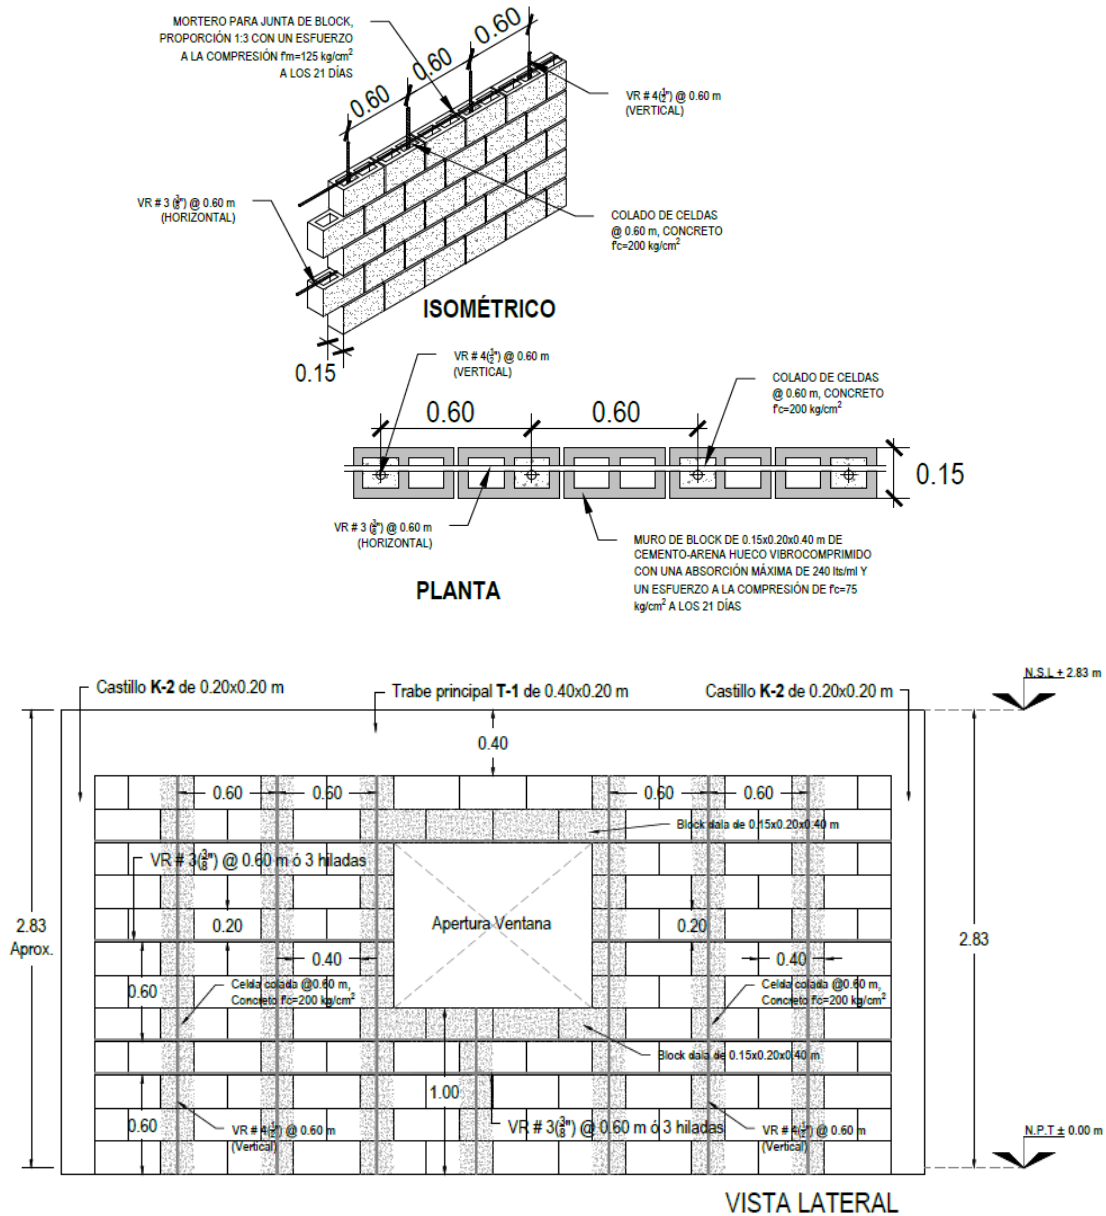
Armado de muros con mampostería de bloque hueco (elaboración propia) (véase en anexos).
